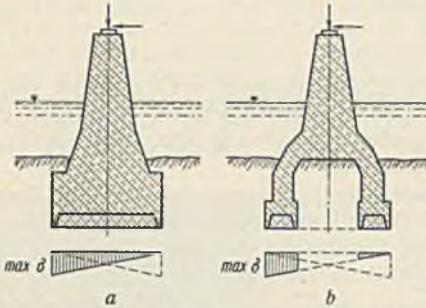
u. b. Bremspfeiler mit gewöhnlichem und mit Ringsenkkasten.
